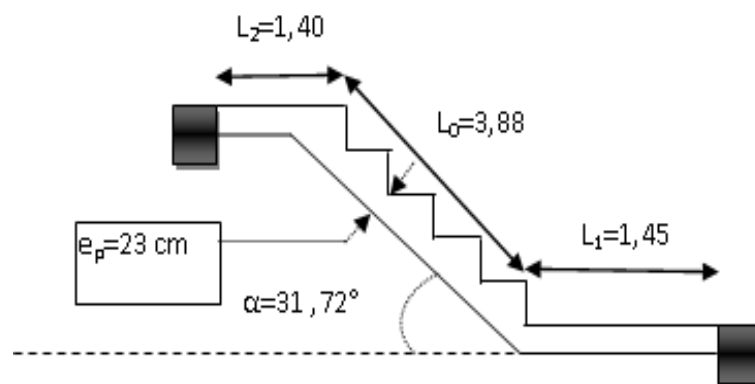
Coupe verticale de la volée d'étage courant
